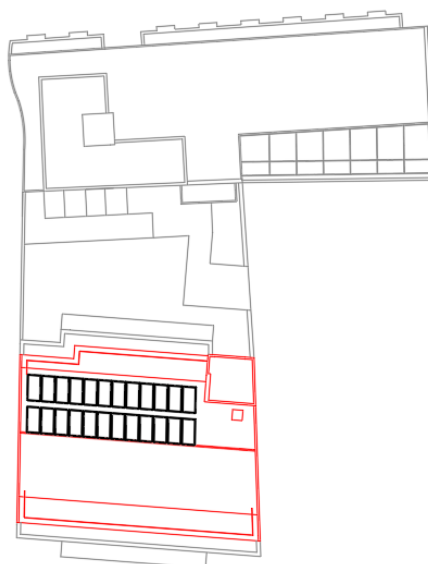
Local de instalação dos painéis solares híbridos na cobertura.
